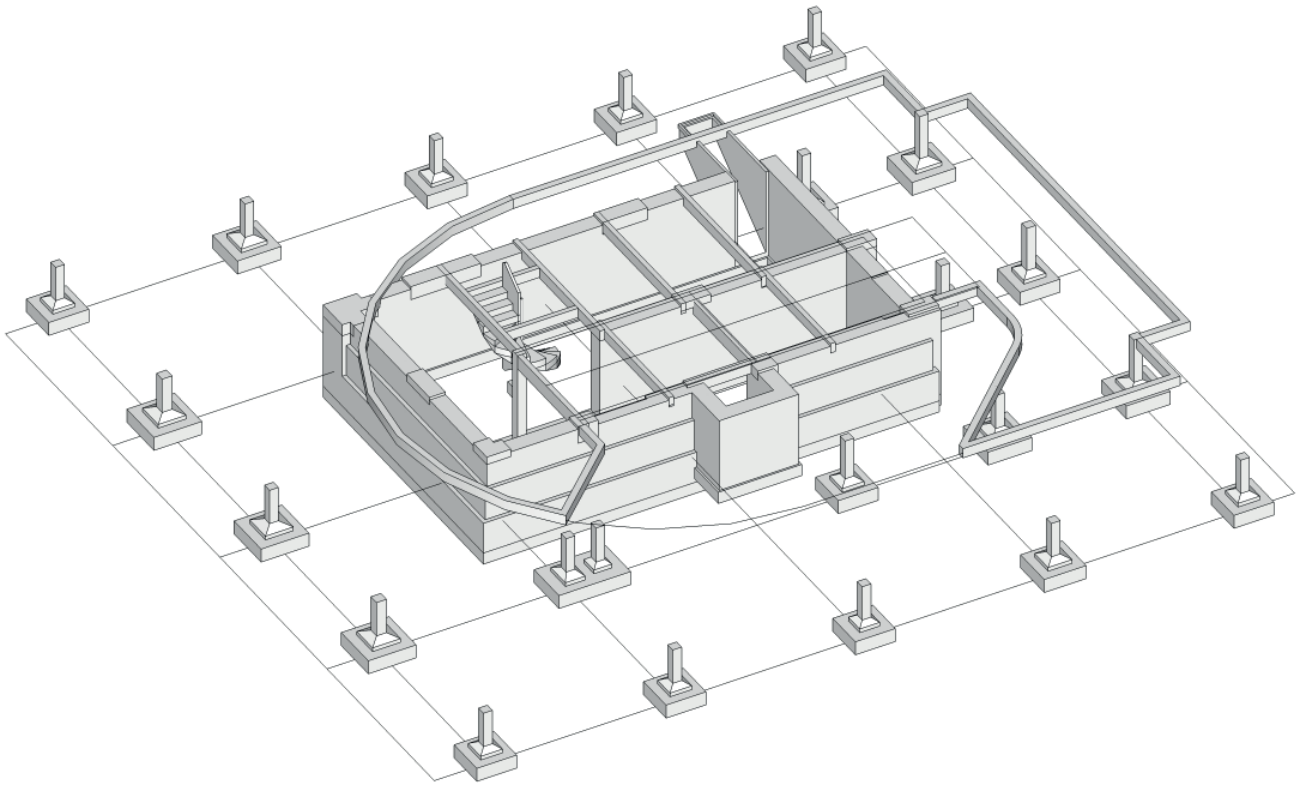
Axonometría de cimentación y forjado de techo de sótano de la Villa Savoye. Elaboración propia.
